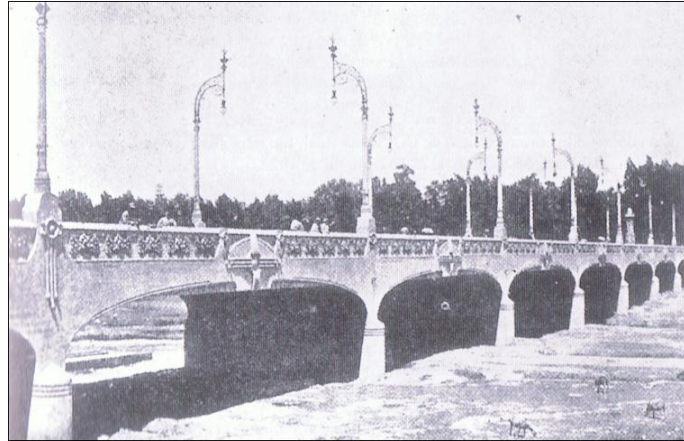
Puente de la exposición de Valencia, 1909. Construido por J.Auban.
